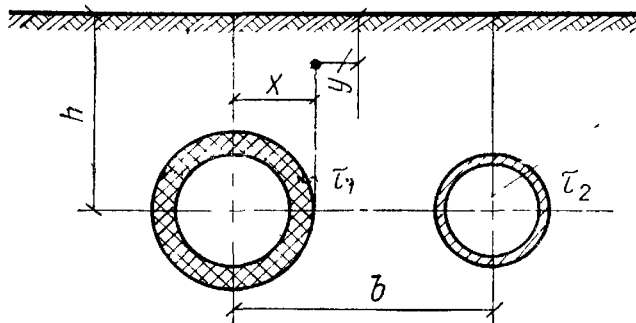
Схема двухтрубного теплопровода при бесканальной прокладке
